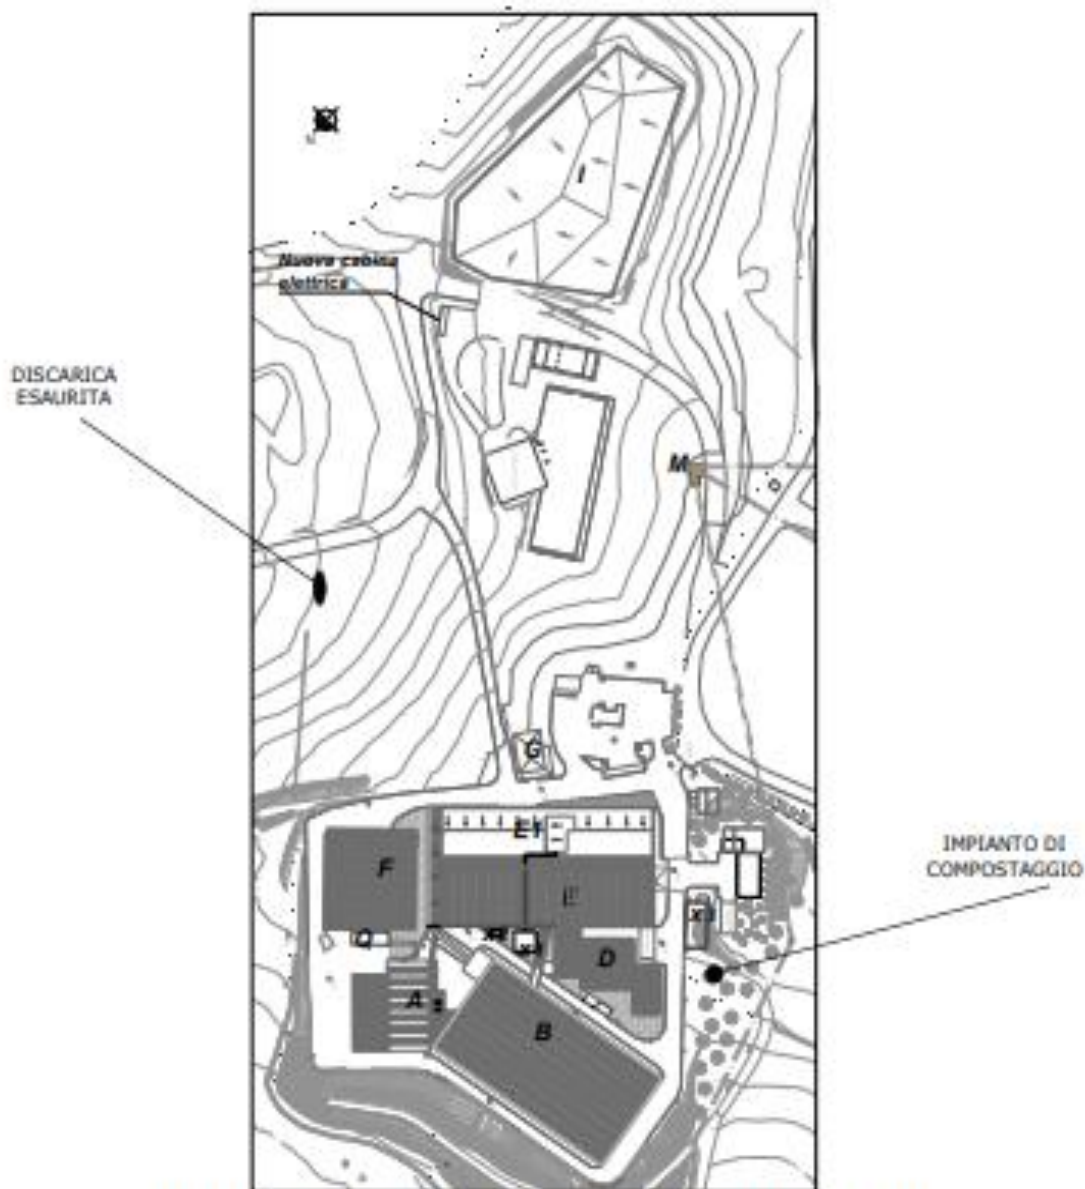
Planimetria del complesso impiantistico di Ca' Baldacci
